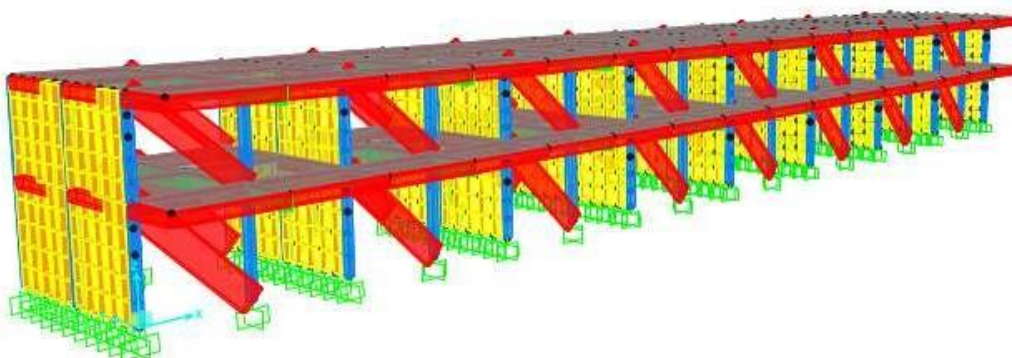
Modelamiento estructural en SAP2000 del plan de refuerzo 2
